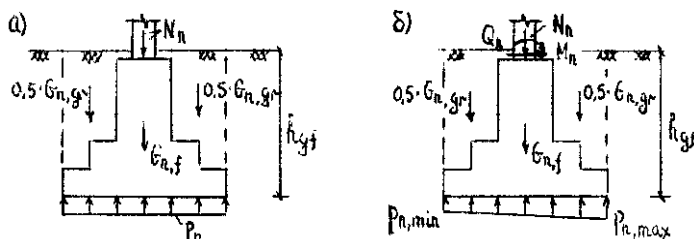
Расчётные схемы к определению размеров подошвы отдельного фундамента: а – центрально нагруженного, б – внецентренно нагруженного
